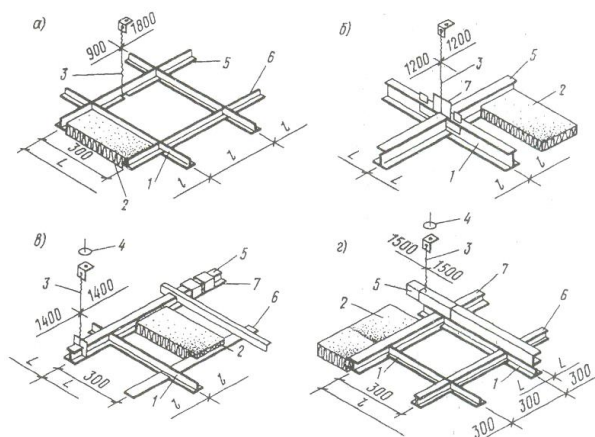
Подвесные потолки из плит «Акмигран» или минеральных плит:
